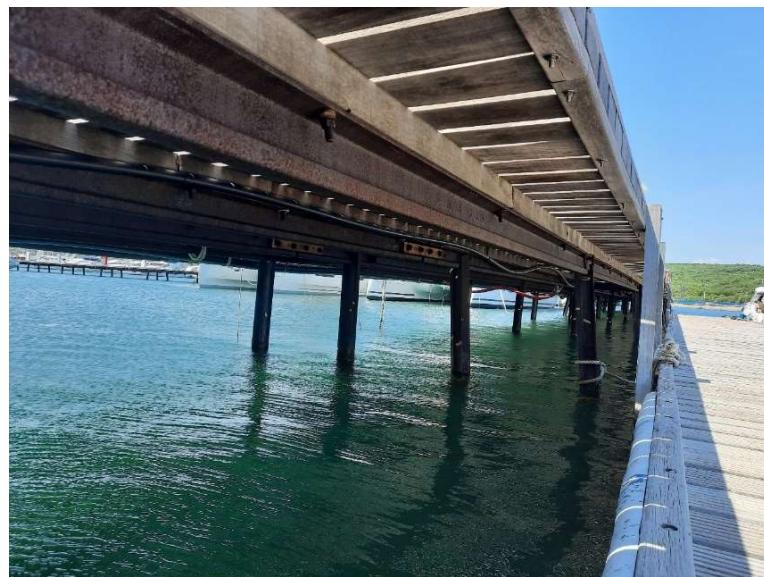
Fotografija prilazne rampe između gatova B4 i B5 (foto autor)
